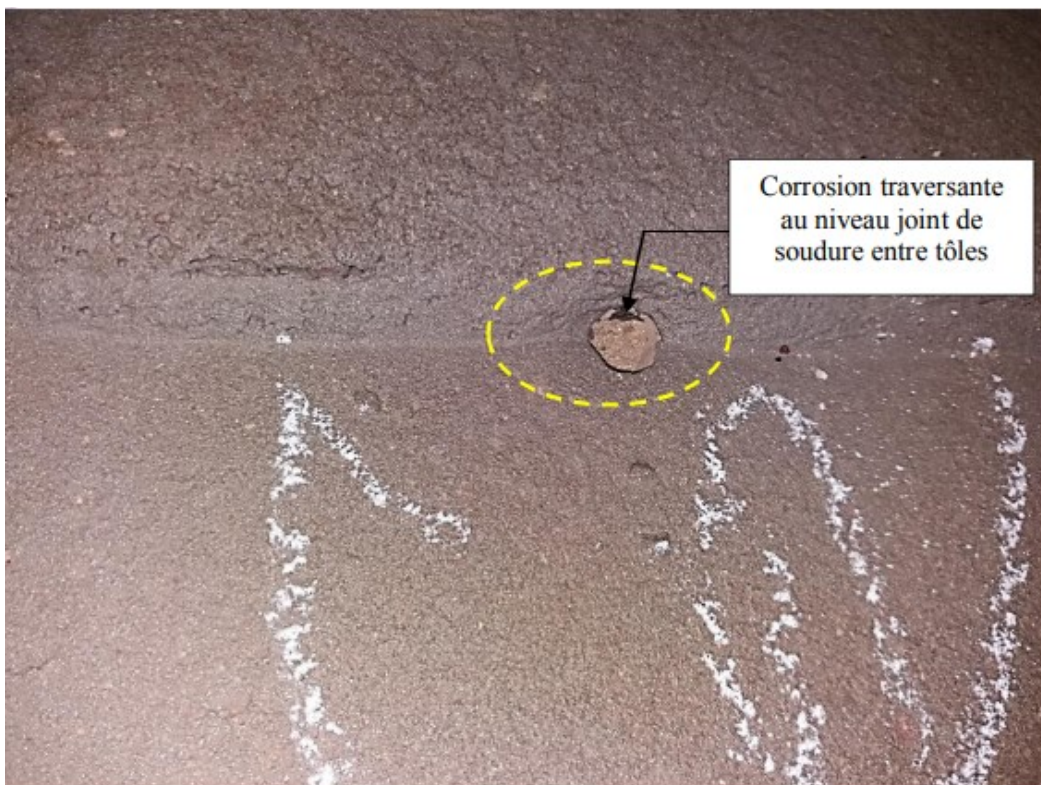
Corrosion traversante au niveau joint de soudure entre tôles
